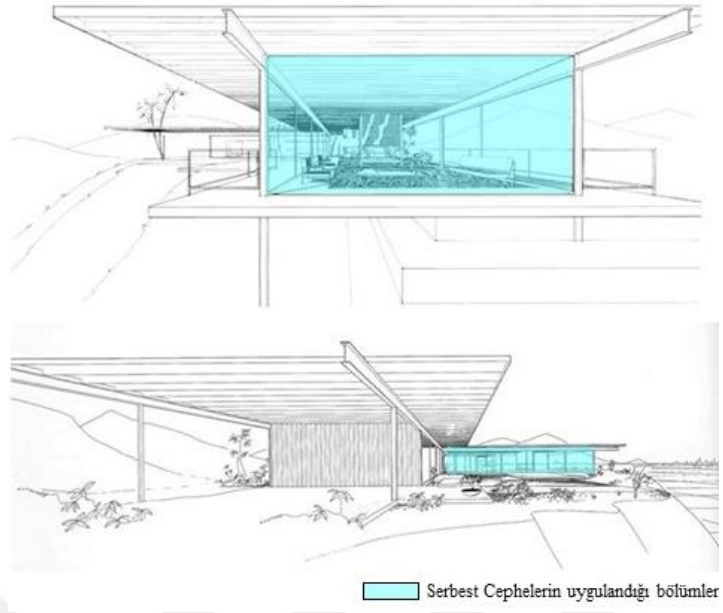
Stahl House yapısı(Kroll, ArchDaily, 2010)
